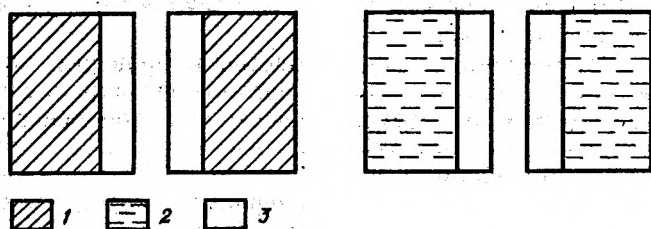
Схема переоборудования помещений на ферме при наличии четырех помещений.
